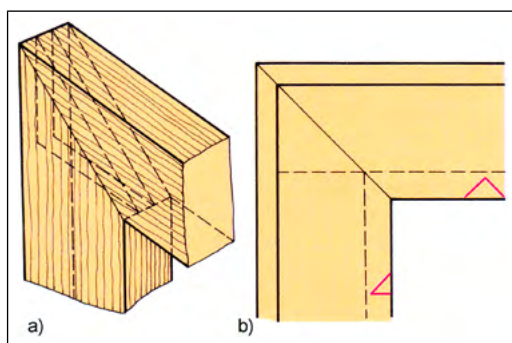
Schlitz und Zapfen beidseitig auf Gehrung a) Schema, b) mit Nut und Außenfalz (Vorderansicht)
